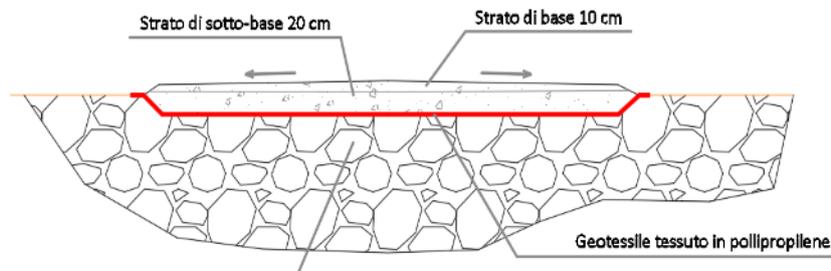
Sezione trasversale tipo della viabilità interna al sito
